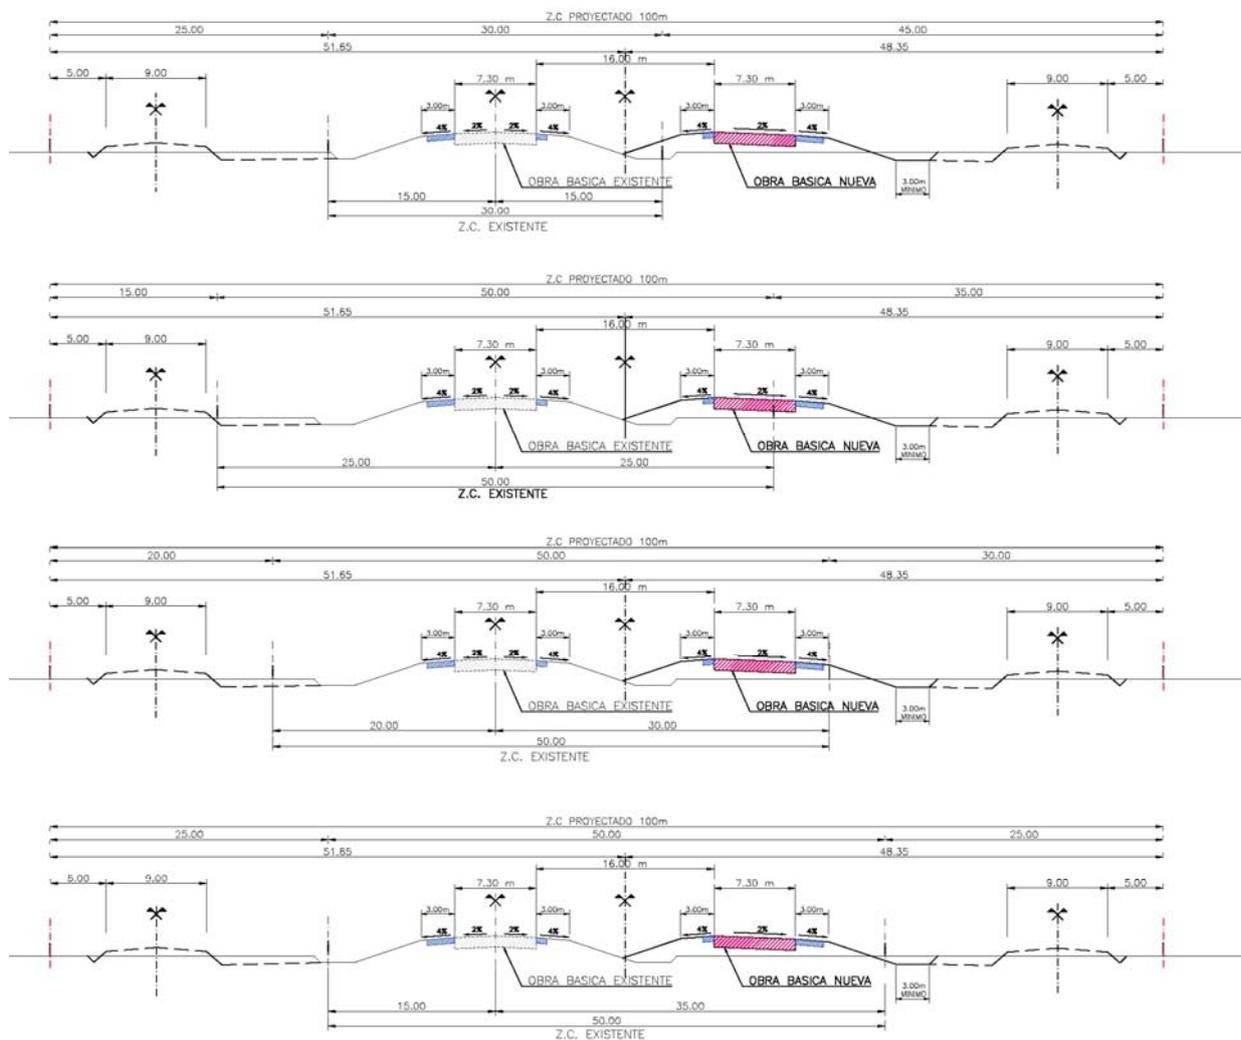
Perfiles de duplicación de calzada con ZC actual de 30 y 50 m.
